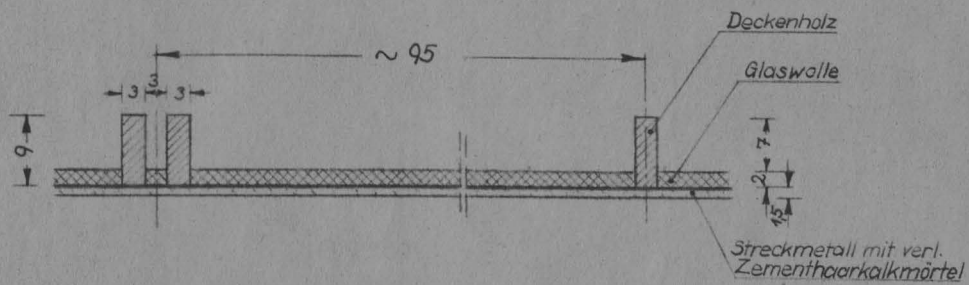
Querschnitt der Decke zum Dach (Typ B)
